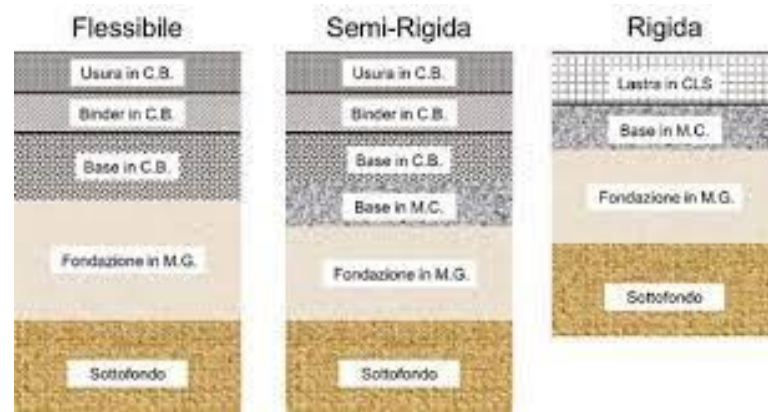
Stratigrafia di un pacchetto strutturale di una pavimentazione stradale
